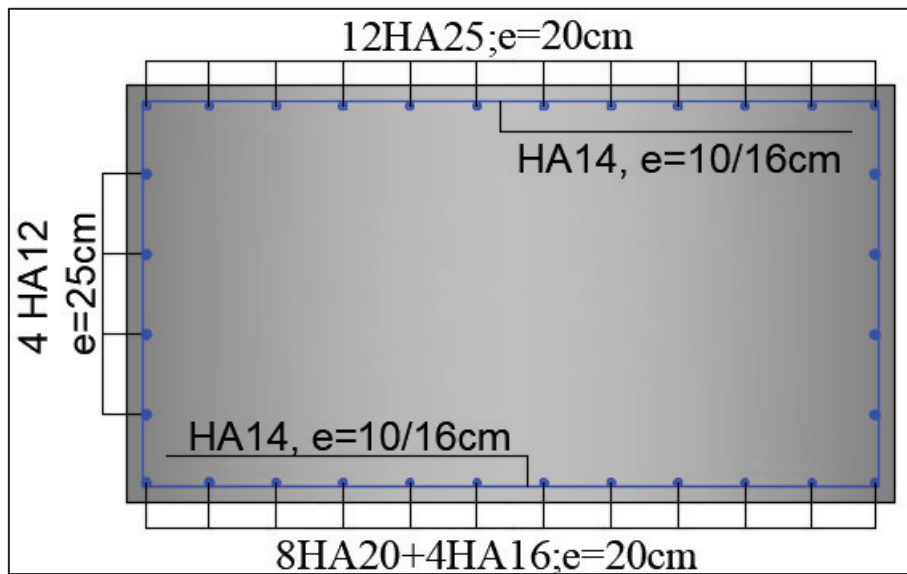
Ferrailage du chevêtre (Coupe Transversale).
